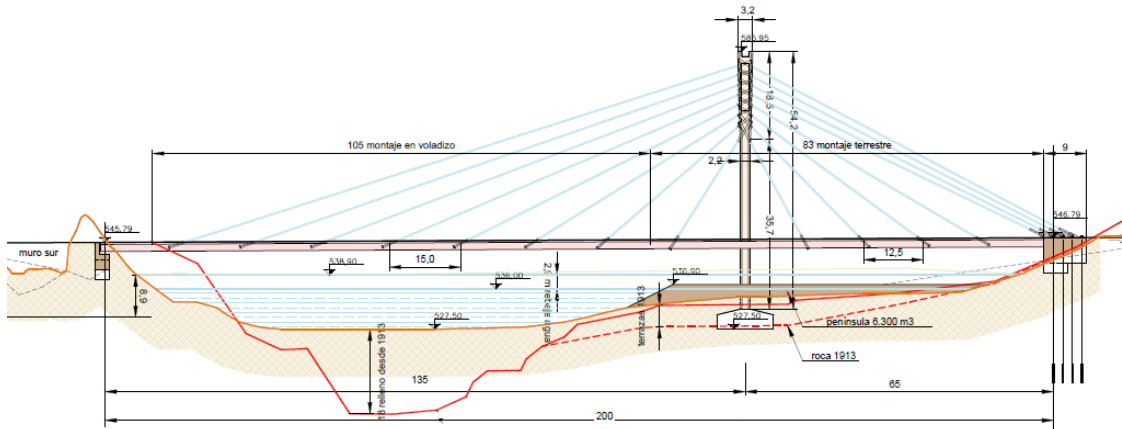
Planta general y alzado este puente atirantado con dos apoyos
